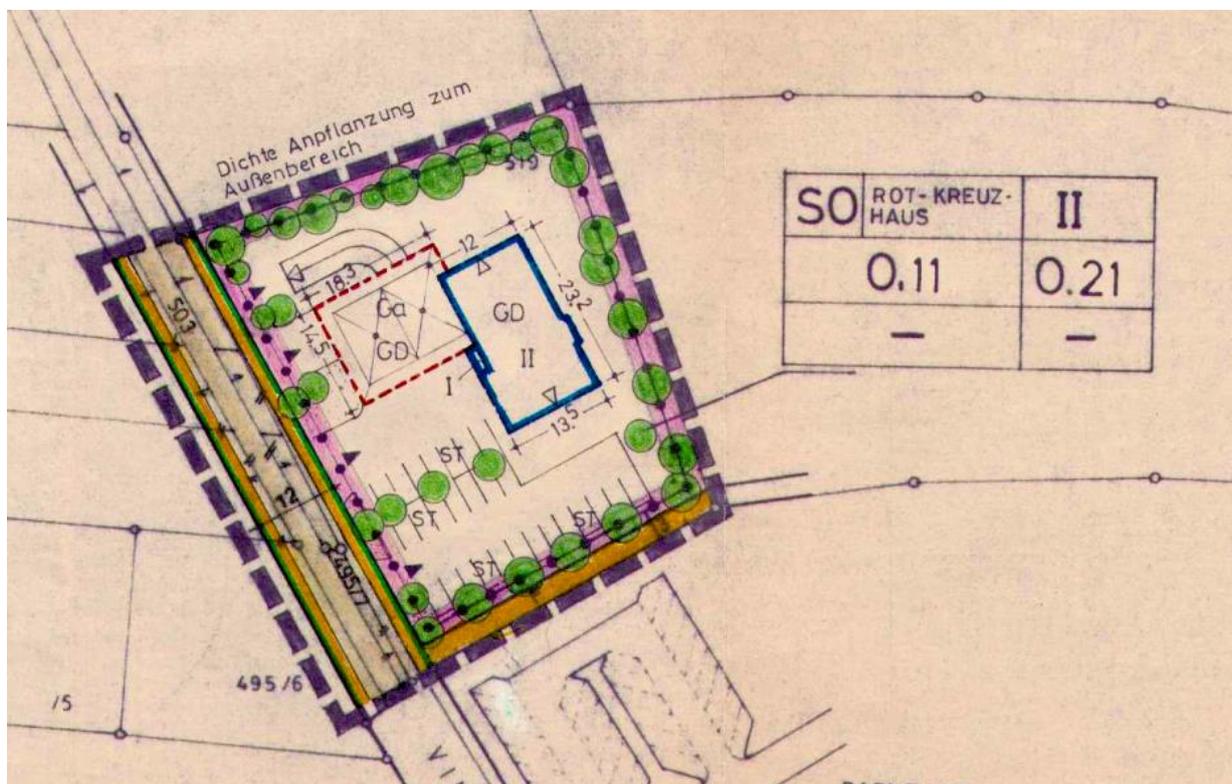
Auszug Bebauungsplan „Rot-Kreuz“ (Urplan)
